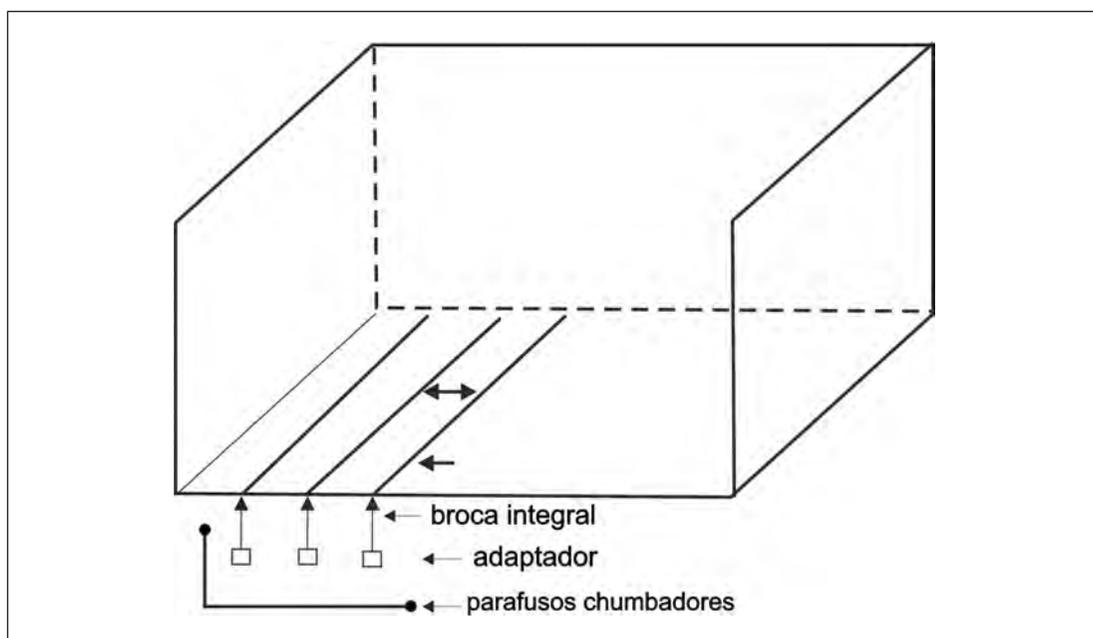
Croqui Explicativo Execução Furos de Levante. Elaboração dos autores.
